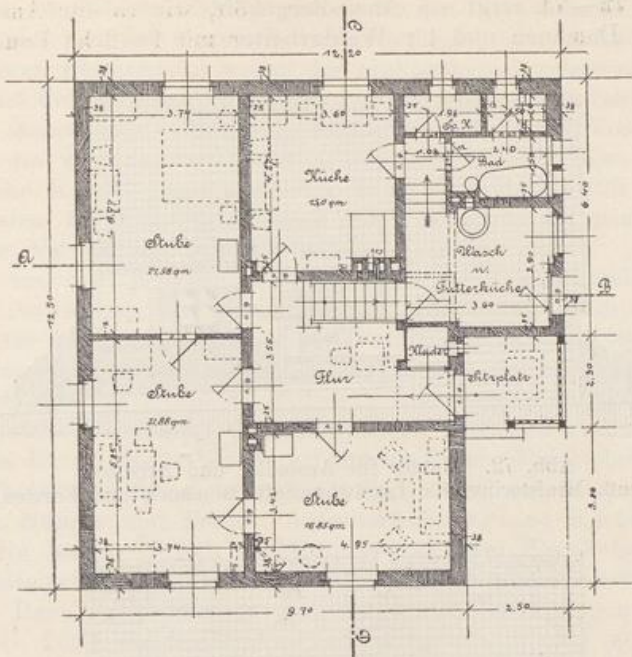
Grundriß zu Abb. 68. Erdgeschoss.
